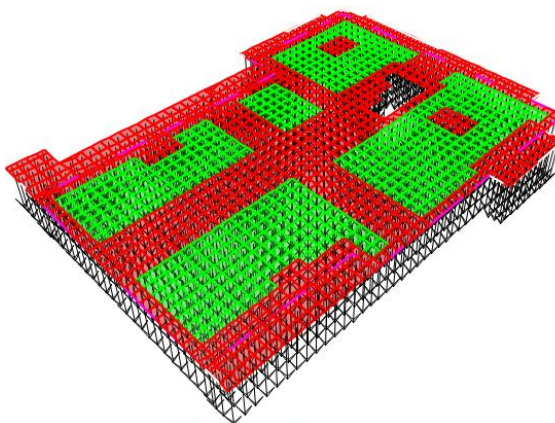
Cargas uniformemente distribuídas nas lajes
